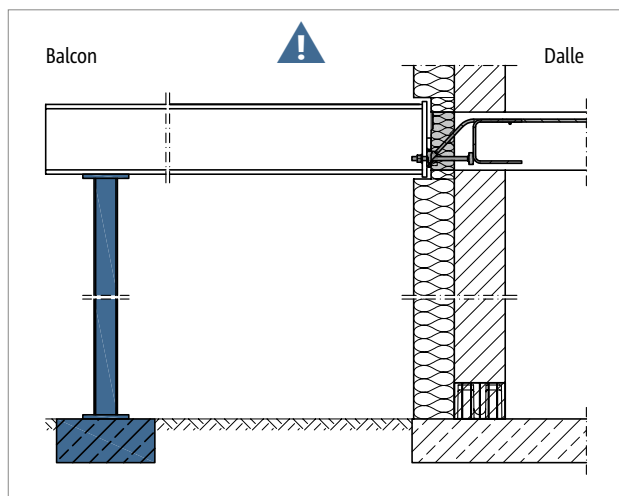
Schöck Isokorb® T type SQ : appui continu nécessaire
